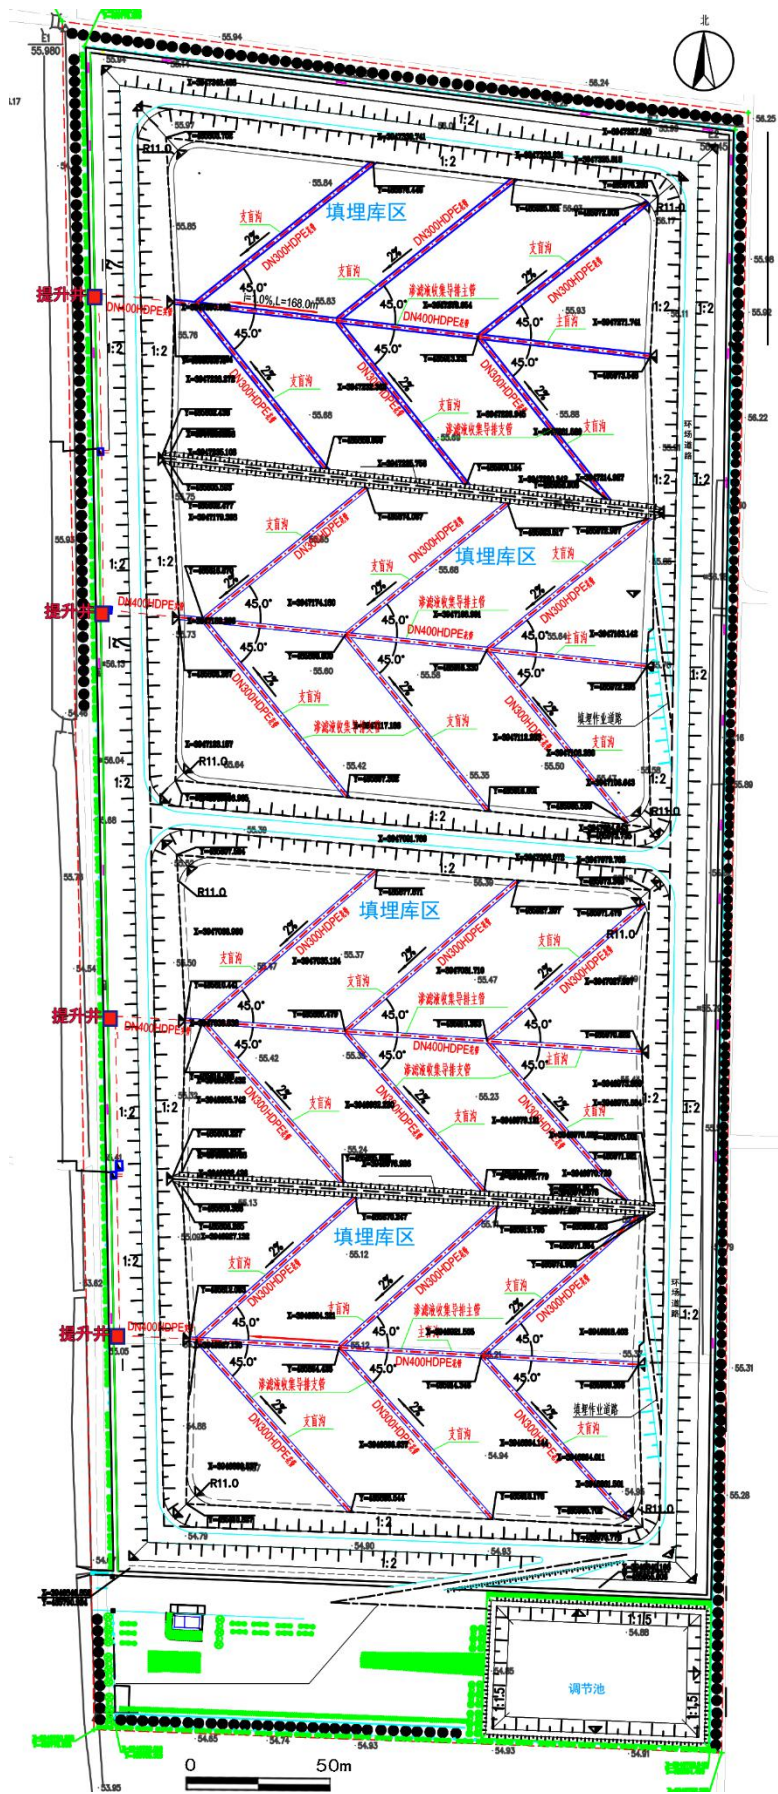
应急填埋场渗滤液导排系统平面布置图
